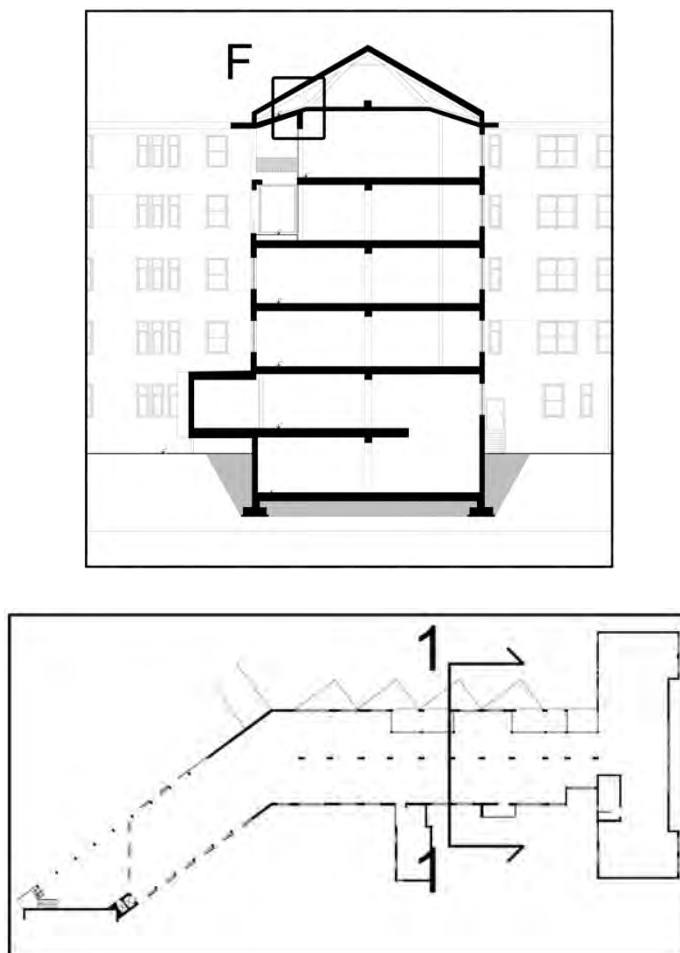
Riferimenti del nodo 1-F in pianta e sezione
